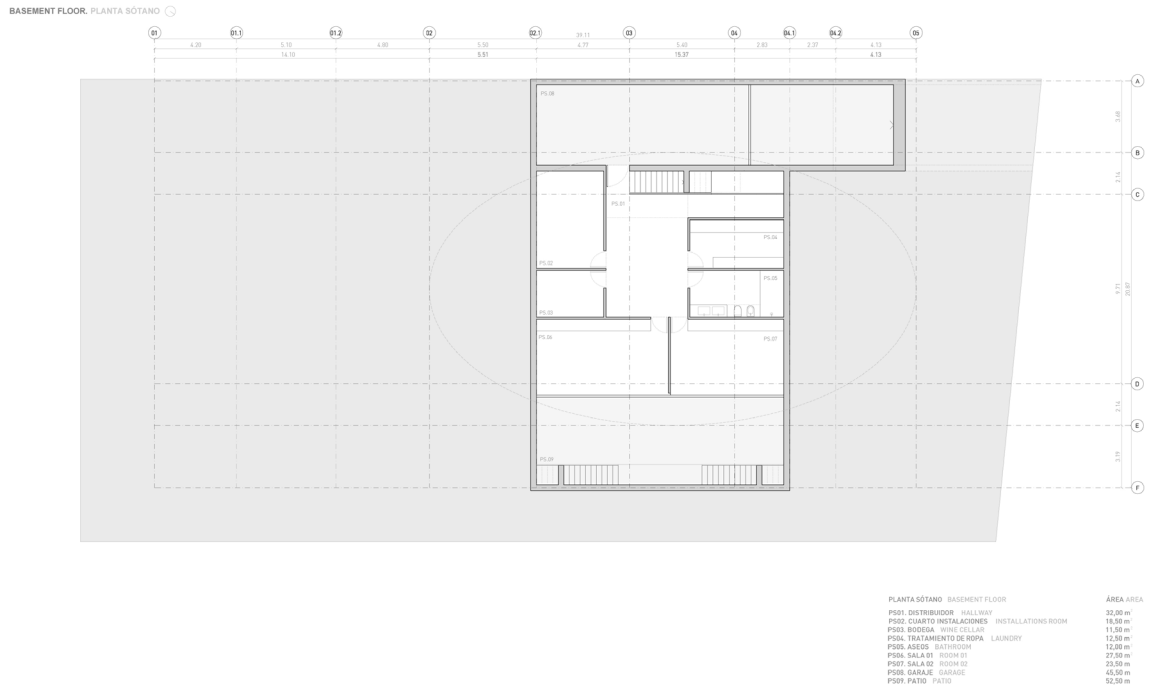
2. Plano planta sótano. Fuente: Fran Silvestre Arquitectos.
